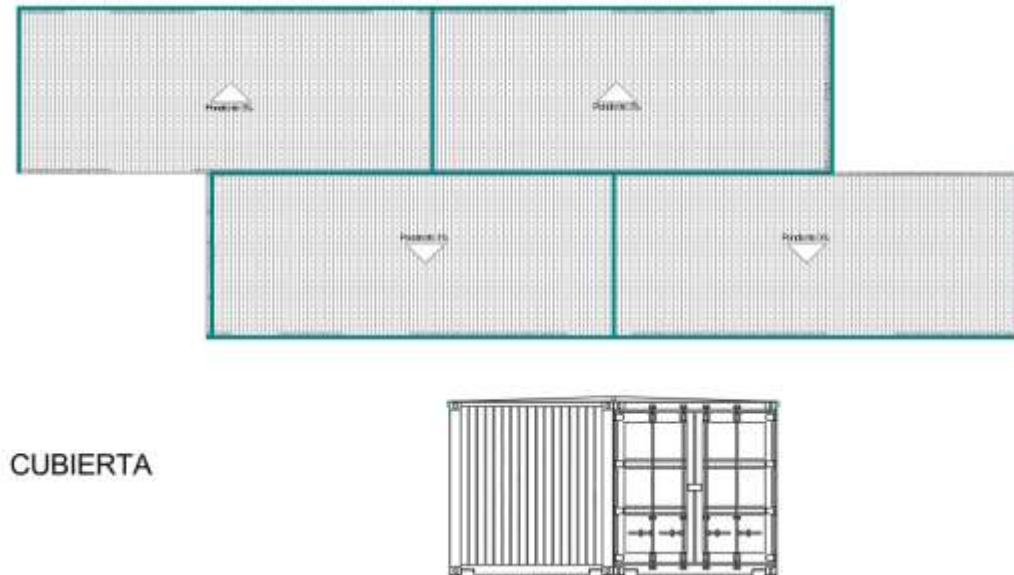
, planta cubierta, 2025-II, Wilson Lozano
